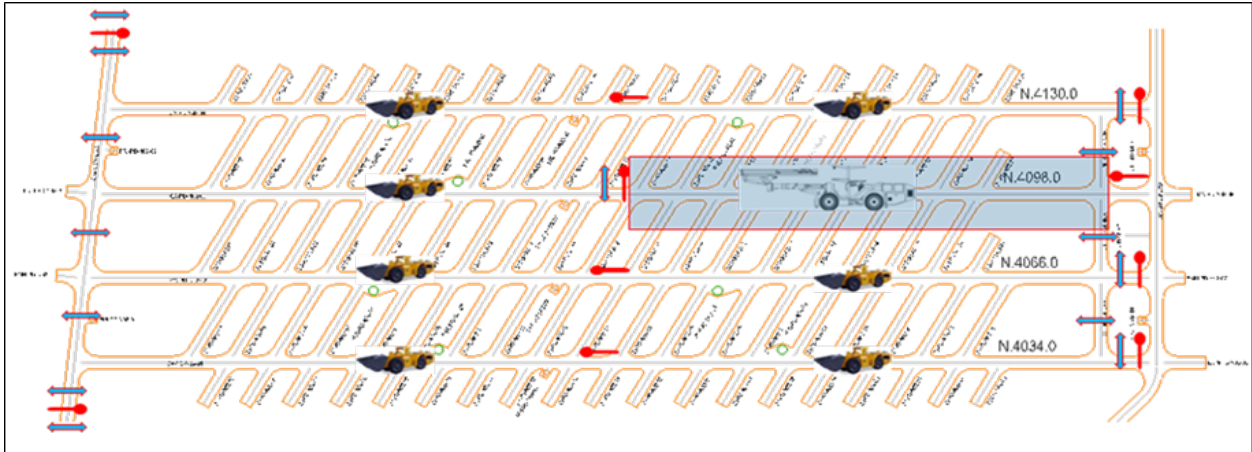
Vista en Planta Nivel de Producción típico Macro Bloque
